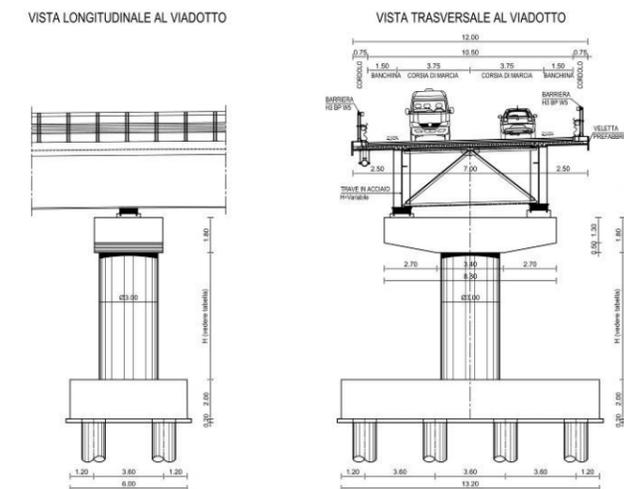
Sezione trasversale e longitudinale del cavalcavia San Giuliano.
